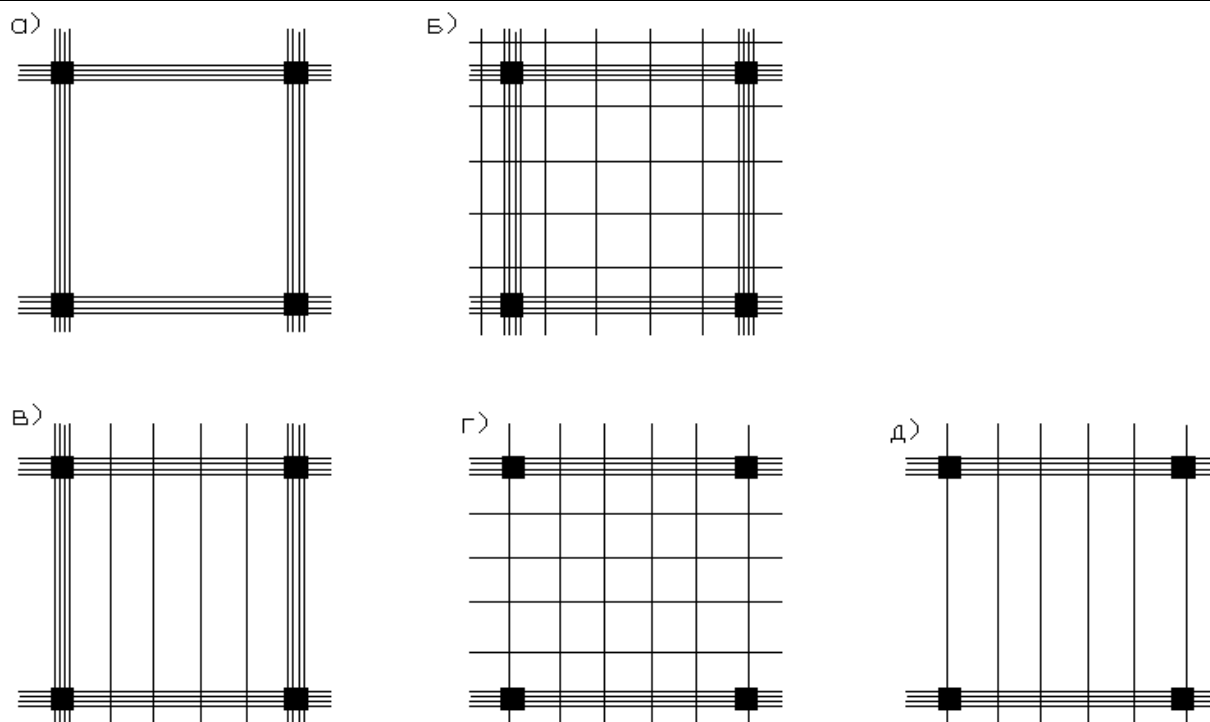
Характерные случаи размещения напрягаемых элементов в плане перекрытия при регулярной сетке колонн
